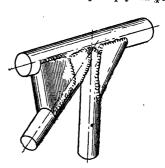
Сварной узел фермы из алюминиевого сплава
